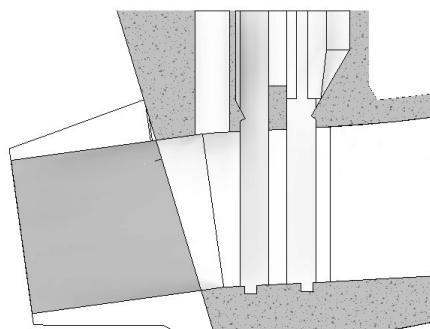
Corte do túnel de adução não explodido (esquerda) e do maciço de suporte (direita).
